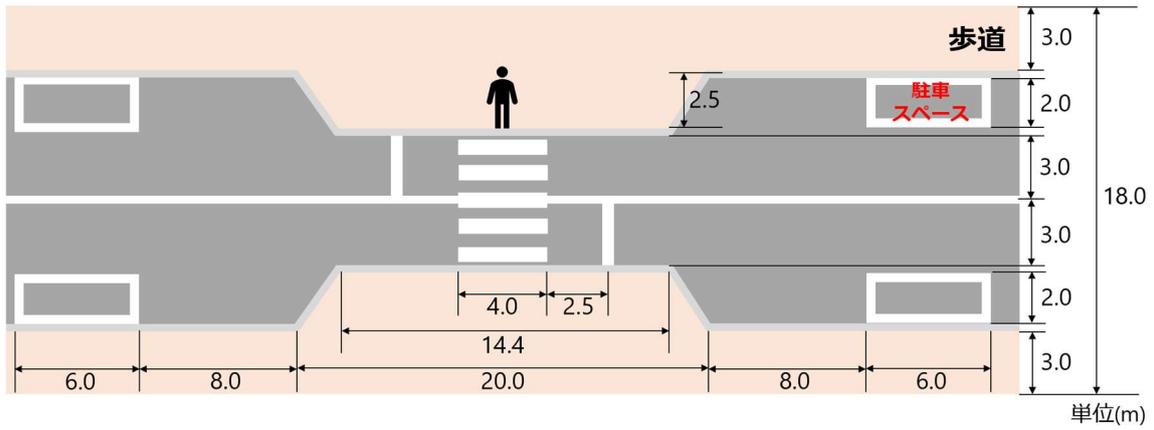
バルブアウト型横断歩道(パターン 5)の平面図
